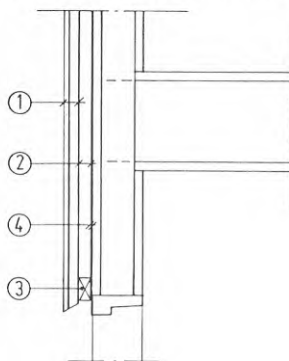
Ny träpanel som fasabeklädnad på befintlig trästomme, tillhörande brandhärdig byggnad (ej tilläggsisolering)
